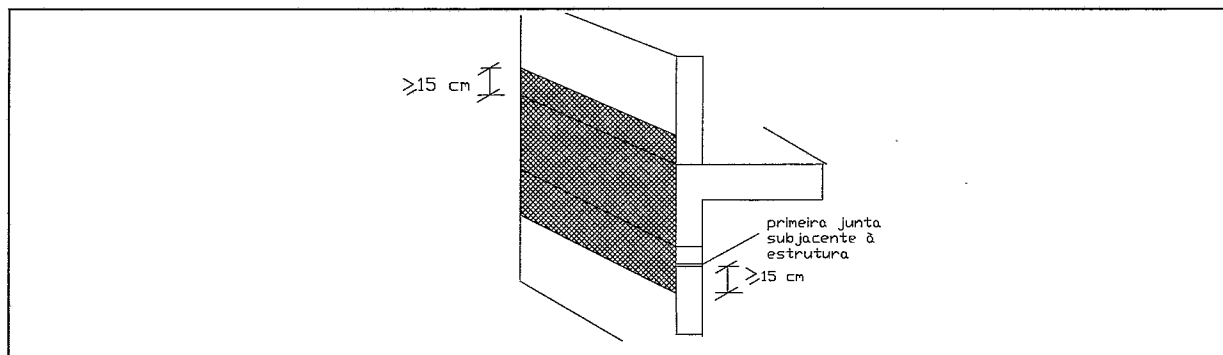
Largura da armadura de reforço do reboco exterior em zona de ligação [8]
